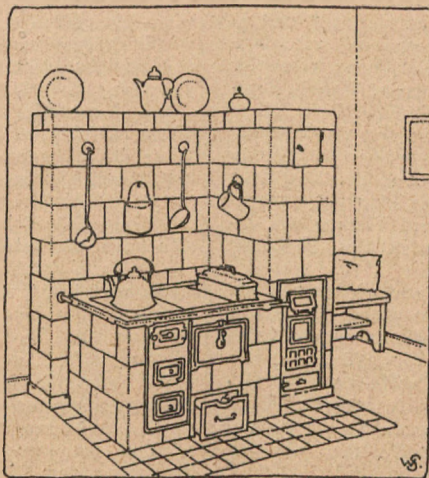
Druna-Zentralluftheizung. Heizofen seitlich an den Küchenherd angebaut. Anlage beheizt im Erdgeschoß Wohnküche und Stube, im ausgebauten Dach 1 bis 2 Schlafkammern.
